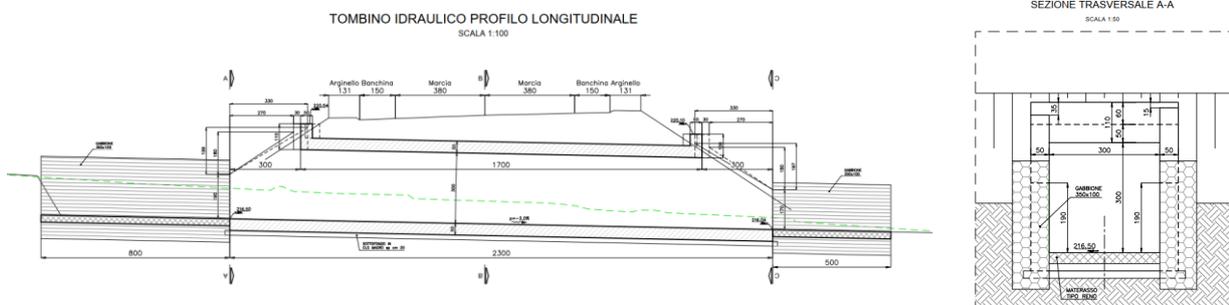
Tombino scatolare (sezione longitudinale e prospetto imbocco)
